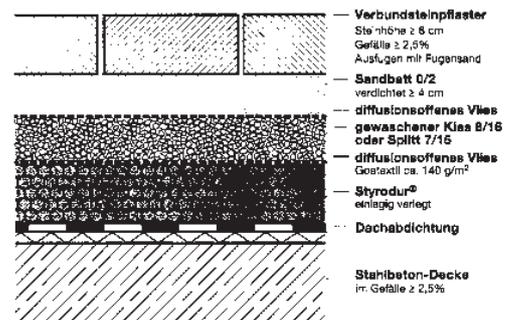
Parkdachaufbau mit Verbundsteinpflaster nach dem Umkehrdach-Prinzip. Über der Dämmschicht muß eine diffusionsoffene Schicht aus gewaschenem Kies 8/16 oder Splitt 7/15 angeordnet werden, um ein Durchfeuchten der Dämmschicht infolge Tauwasseranreicherung zu vermeiden
